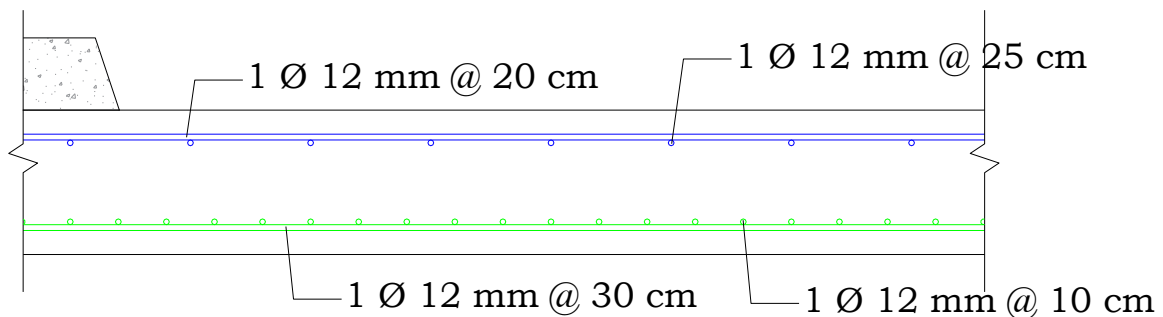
Vista transversal de losa entre apoyos con distribución de acero. Elaborado por: Autores.
